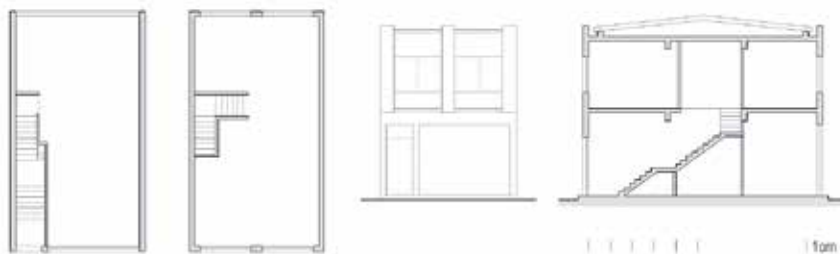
Planimetrías da edificación na Travesía da Caraña n.º 7-9: planta baixa, planta alta, alzado principal e sección lonxitudinal (reinterpretación da autora).
